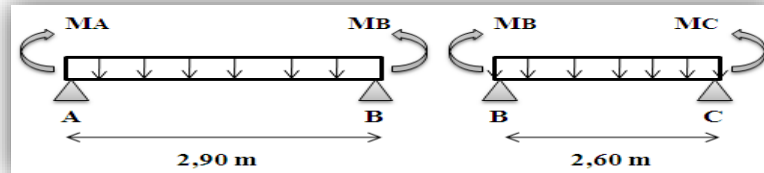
Poutre à deux travées du plancher terrasse inaccessible.
